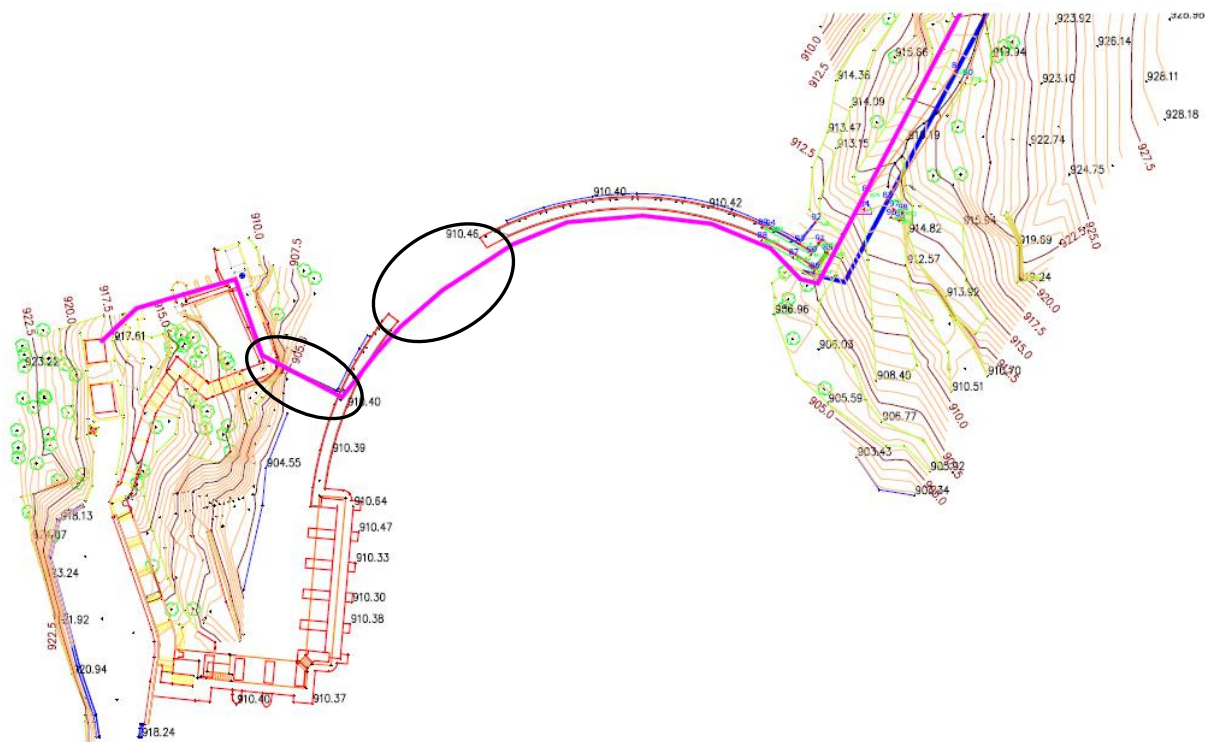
Plano de planta de la zona del azud. Las elipses marcan las pasarelas a proyectar.
